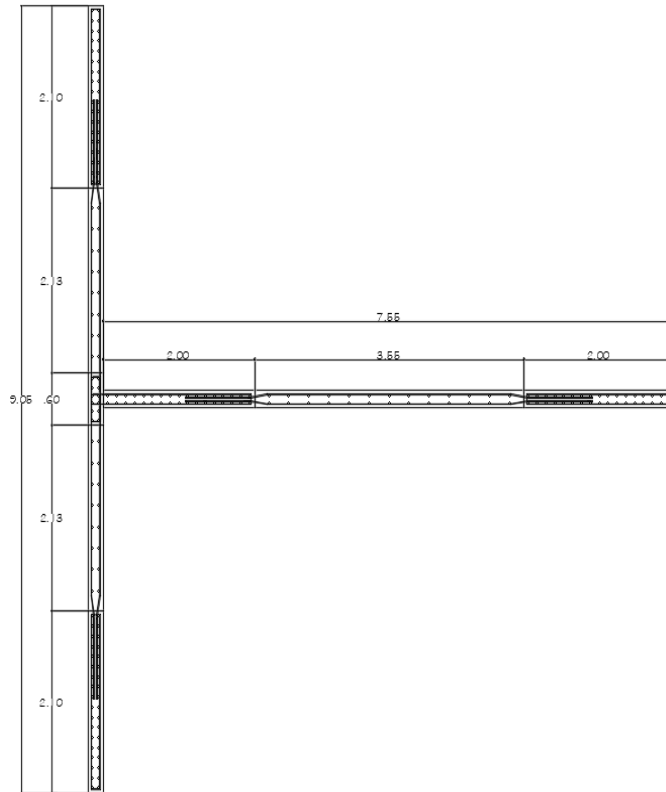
Detalle del refuerzo de los muros, PIER 7A y PIER A. Extraída de ETABS.
